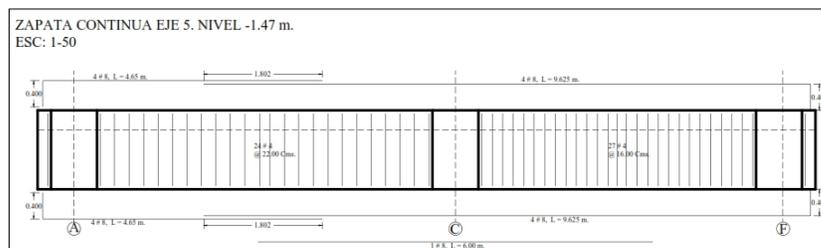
, Detalle viga eje 5, Fuente: Constructora Open House.
